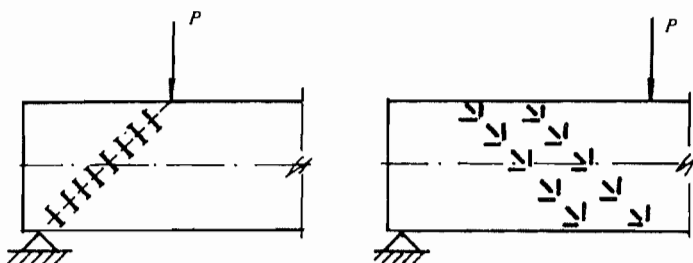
钢筋混凝土梁斜截面抗裂测点布置
